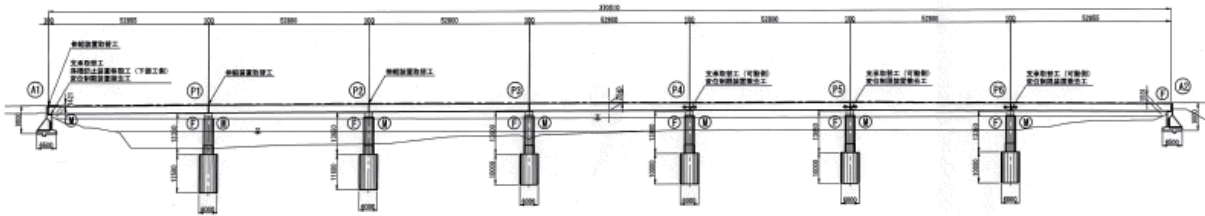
災害復旧一般図(鎌田大橋)
